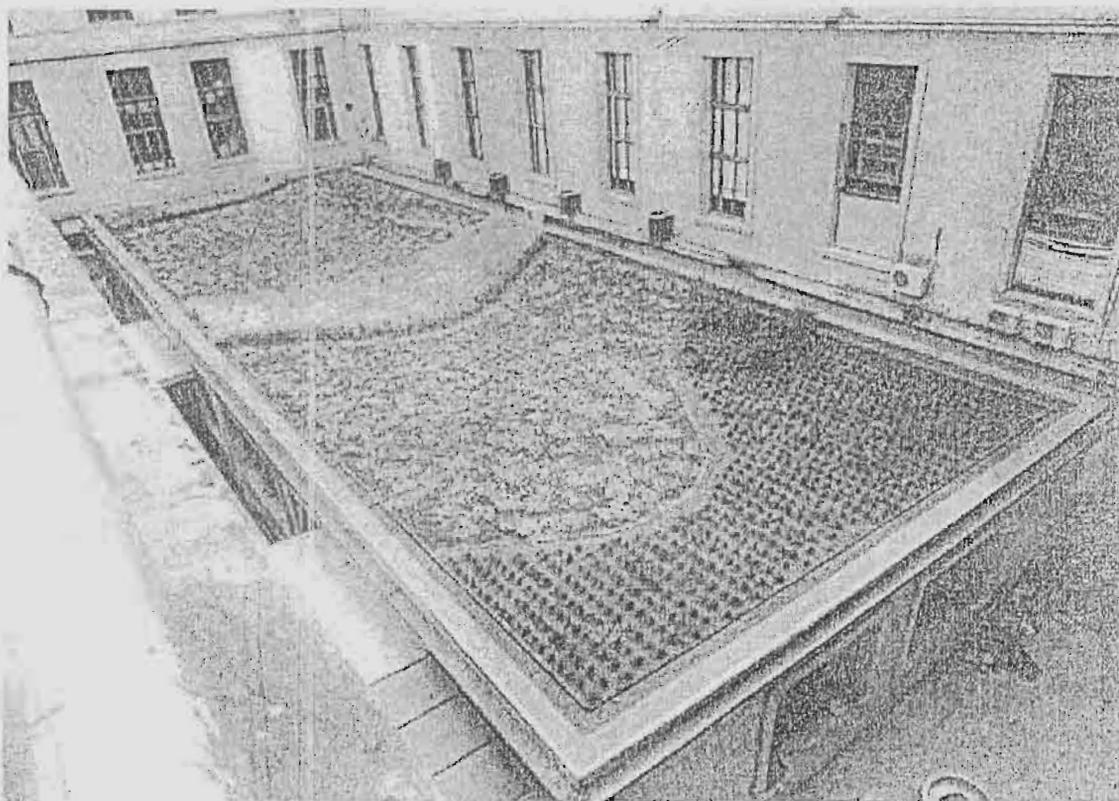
Vista general de cubierta verde Facultad de Derecho
